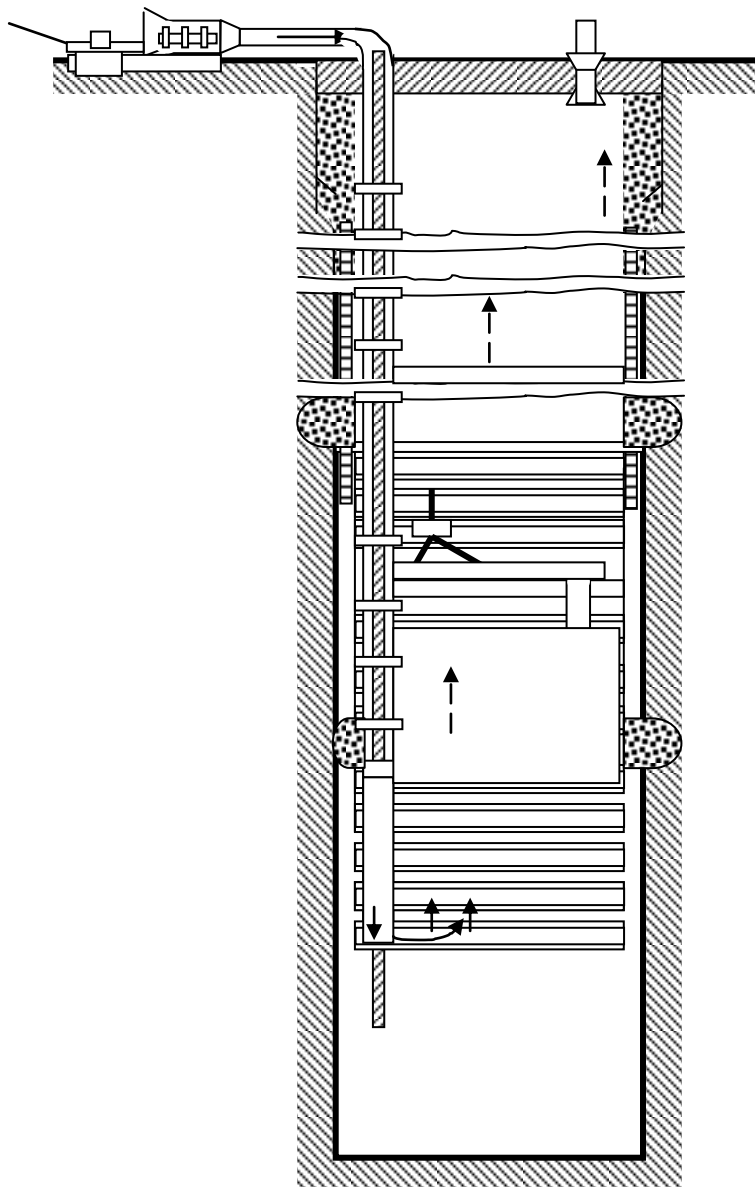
Схема нагнетательного способа вентиляции и размещения трубопровода при проходке ствола
